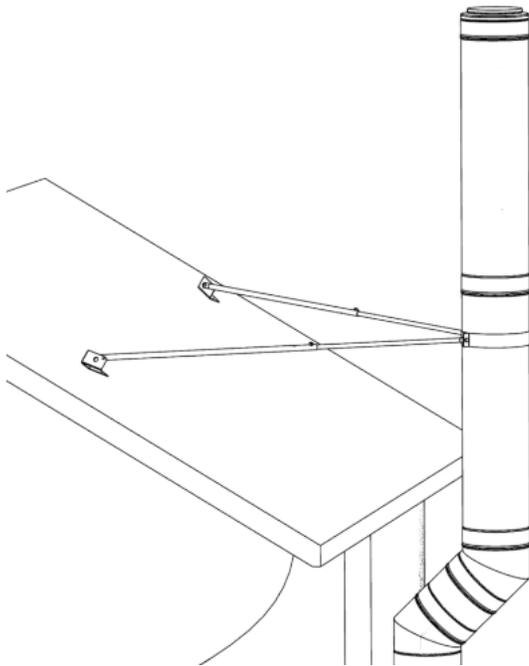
, Fascetta stabilizzante sopra tetto (191)
